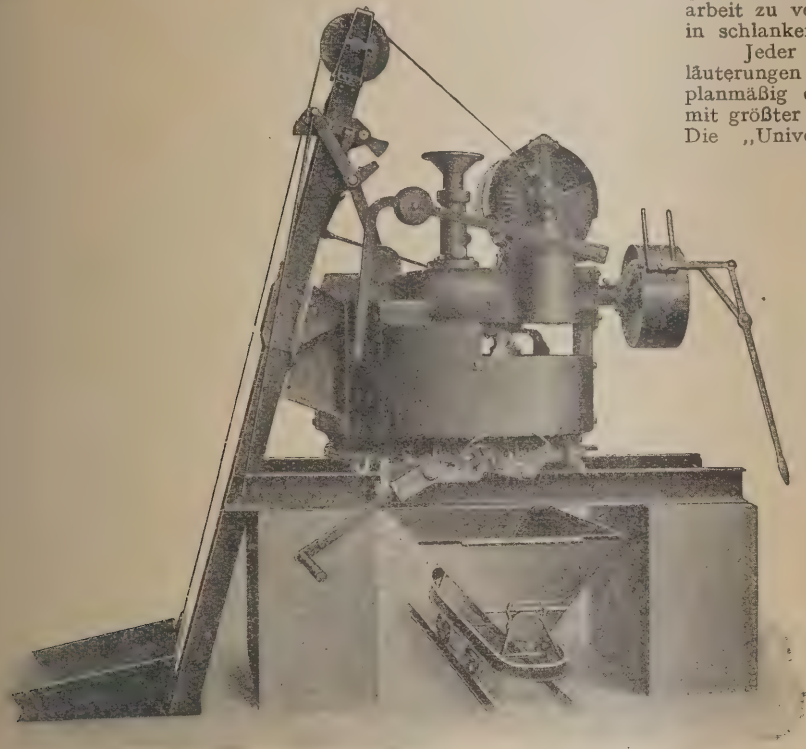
Stationäre Betonmischmaschine „Eirich“.
